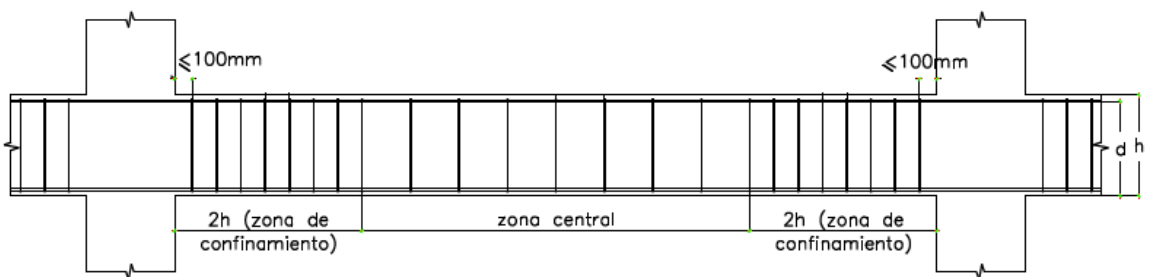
Distribución de estribos en vigas de importancia sísmica
